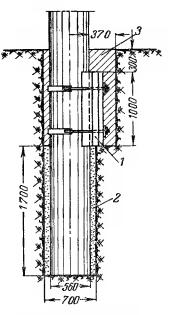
Нижняя часть желевобетонной опоры с верхним ригелем.
